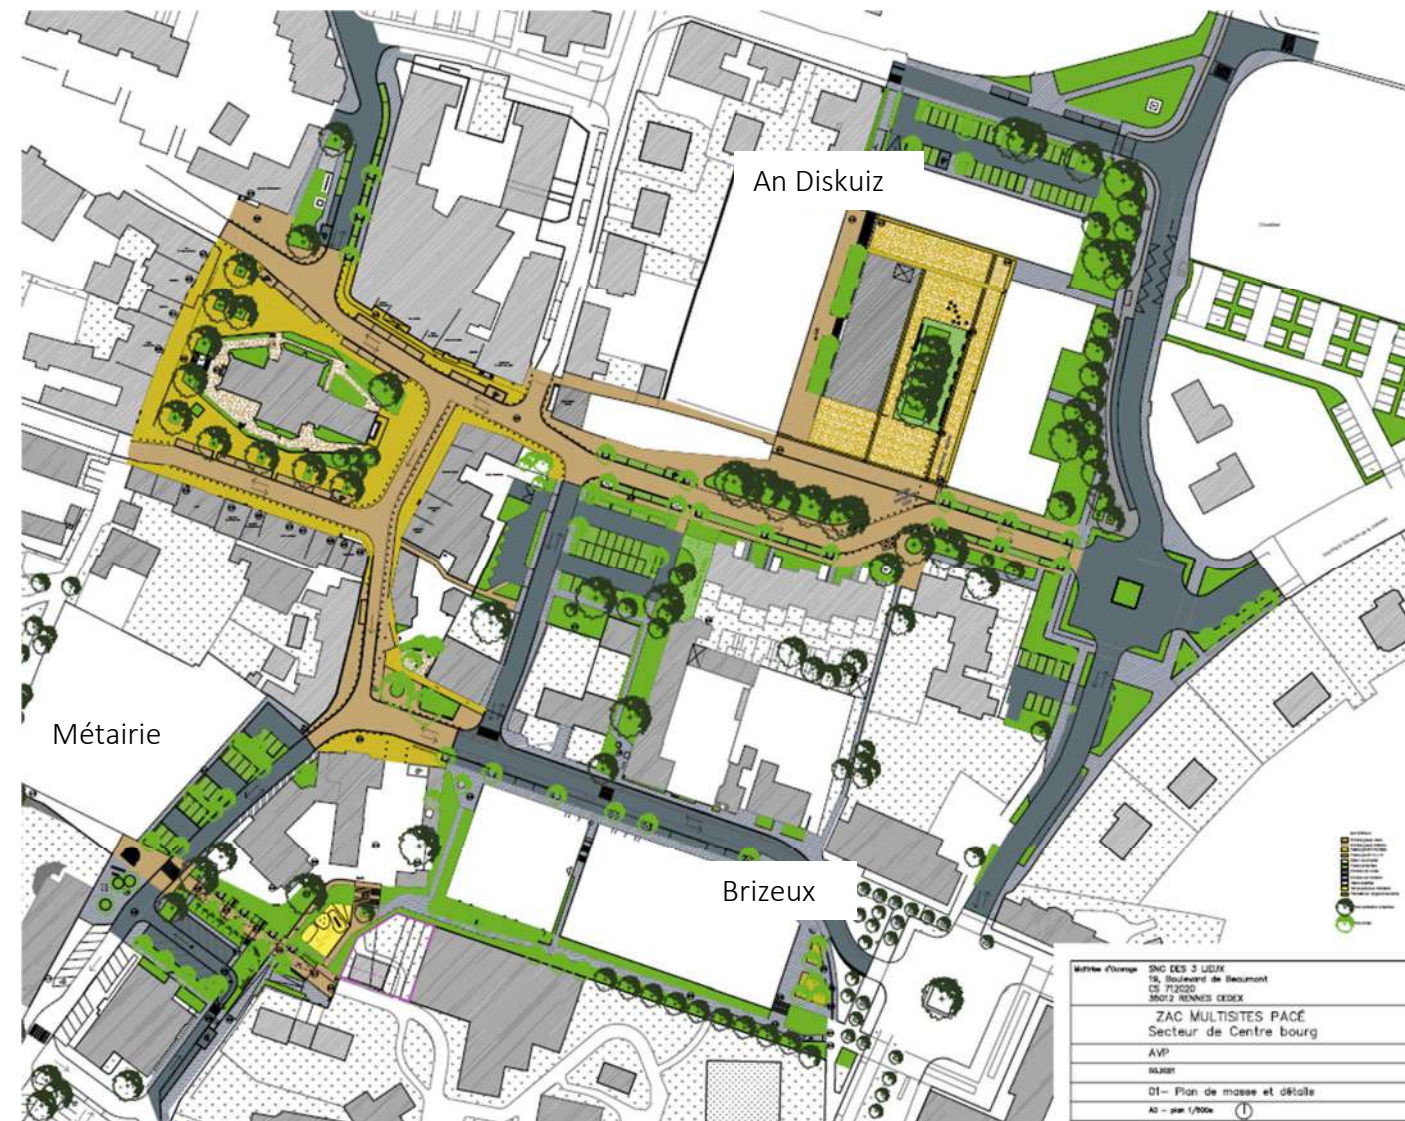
Plan masse du renouvellement urbain du secteur Centre-bourg au stade AVP - Atelier Madec / La Plage Architecture et Paysage, 2022
